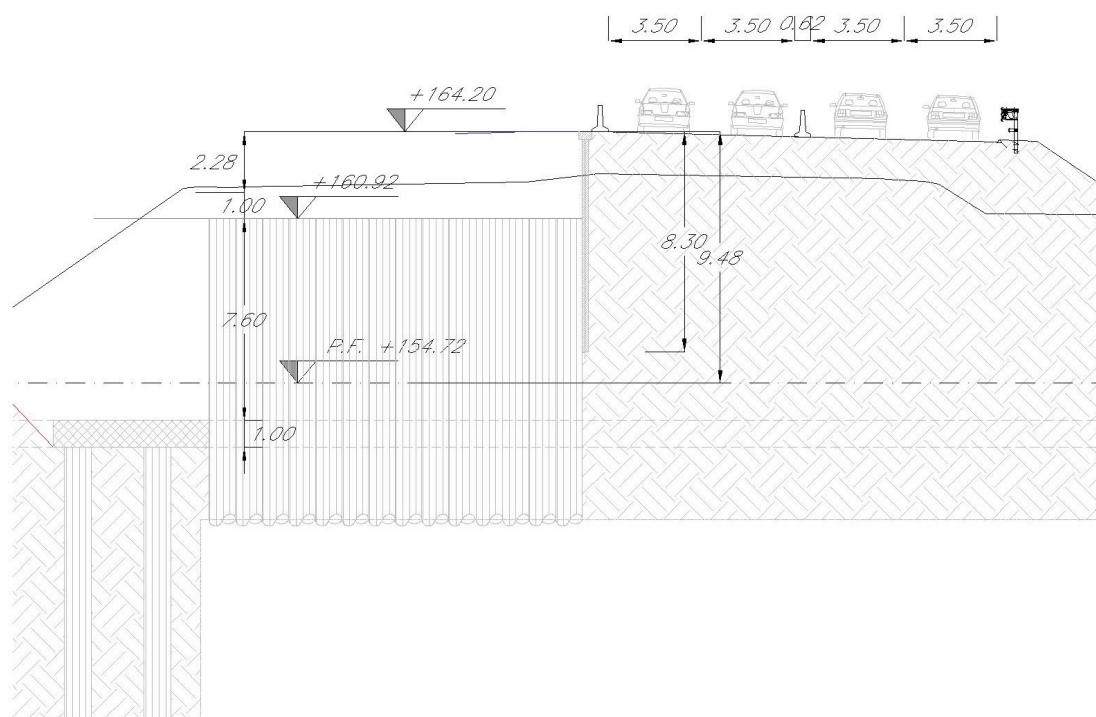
Sezione del manufatto oggetto della presente relazione di calcolo.
